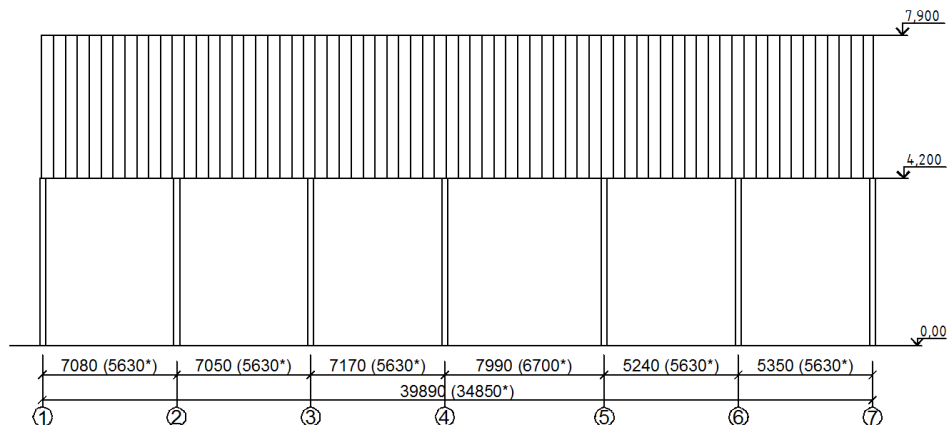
Схематичный план фасада в осях 1...7 (* размеры по проекту) (разработано автором)
